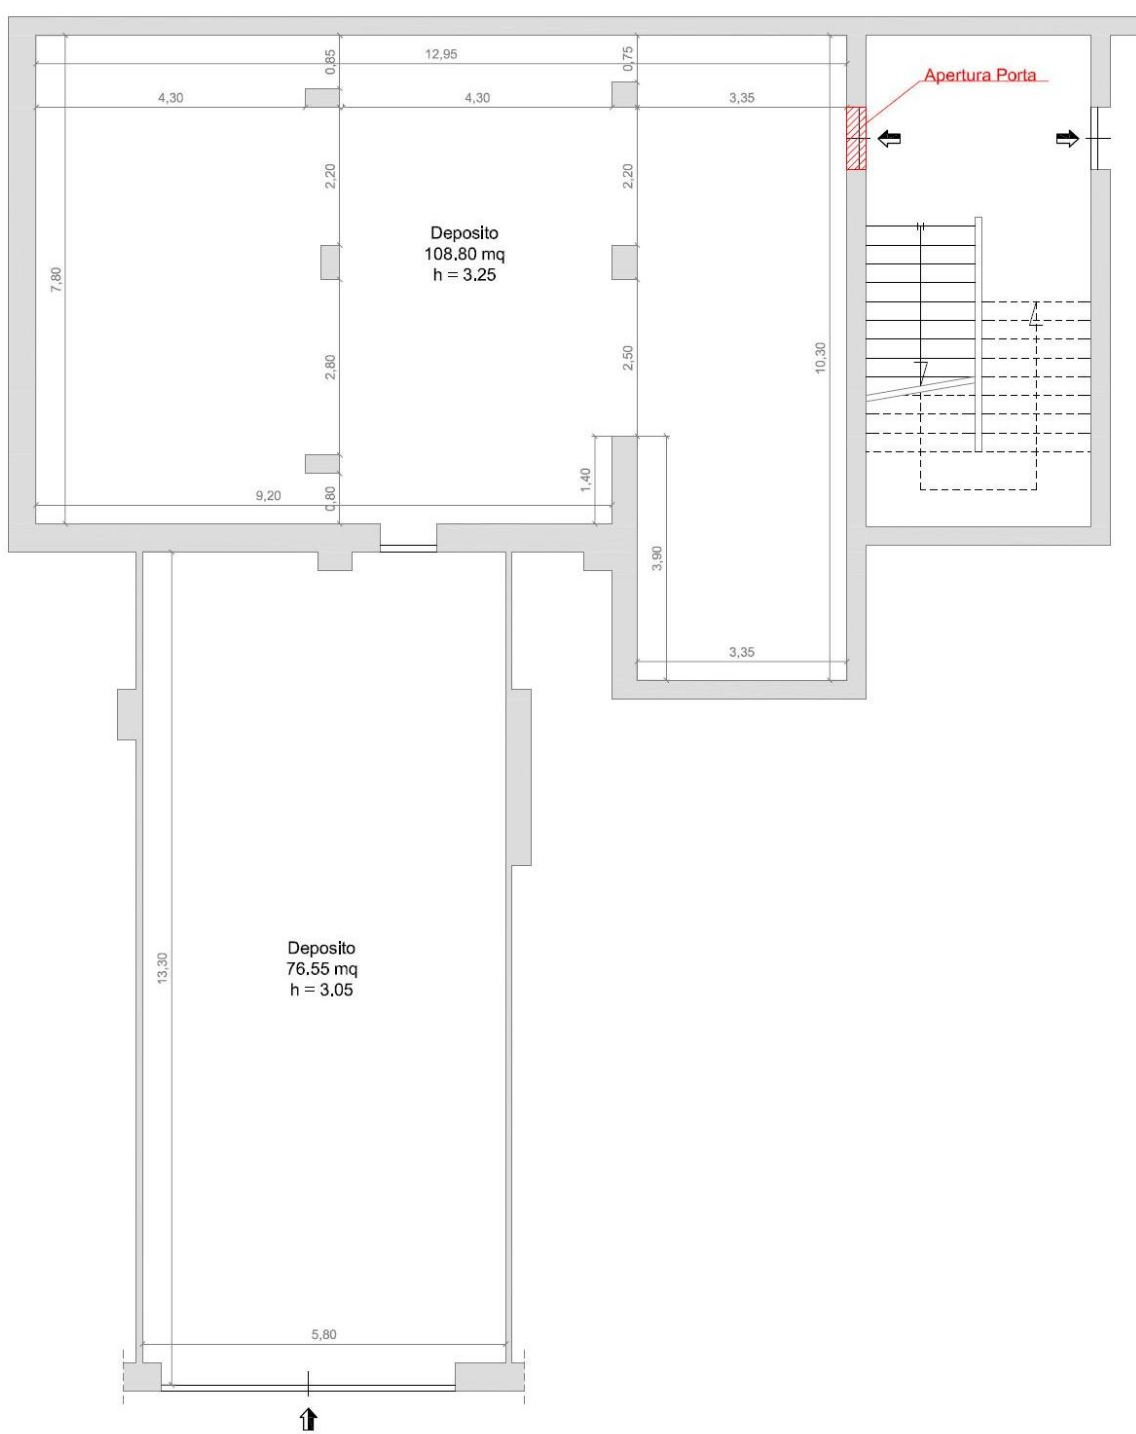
Planimetria Stato di fatto Foglio 46, p.lla 1235, sub 14.
